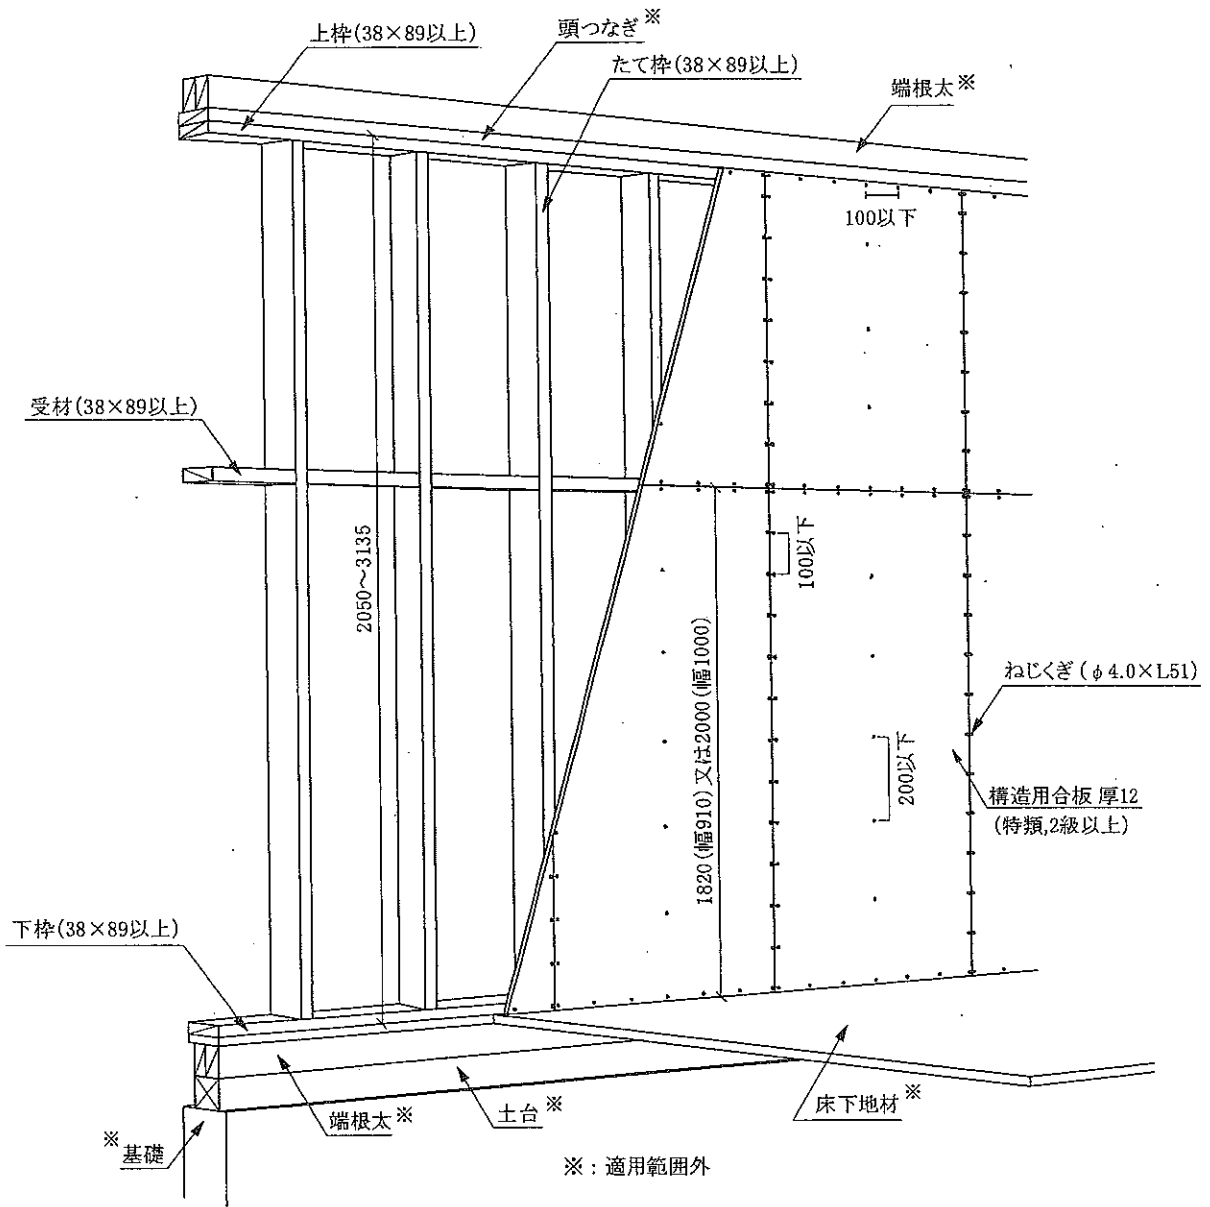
施工図：縦継ぎ張りの場合 (寸法単位：mm)
